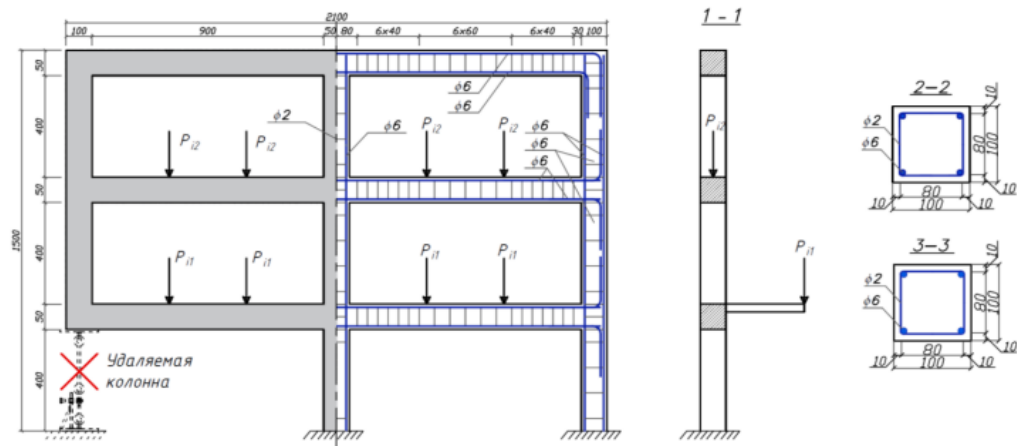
Конструкція залізобетонної рами та схема застосування зовнішніх навантажень
